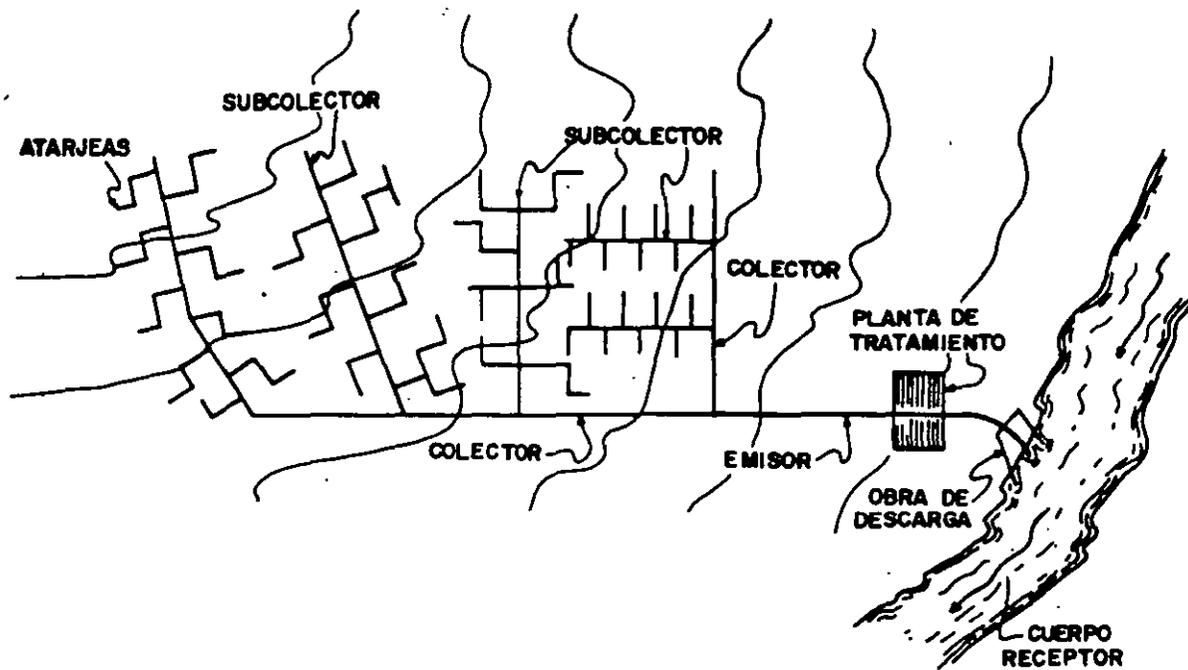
Conductos que forman la red de un sistema de alcantarillado.
